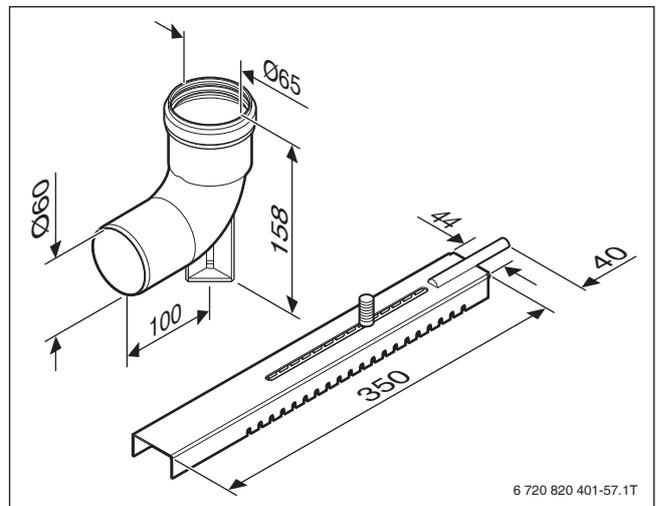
Stützbogen mit Auflageschiene für Ø 60 mm (Maße in mm)
